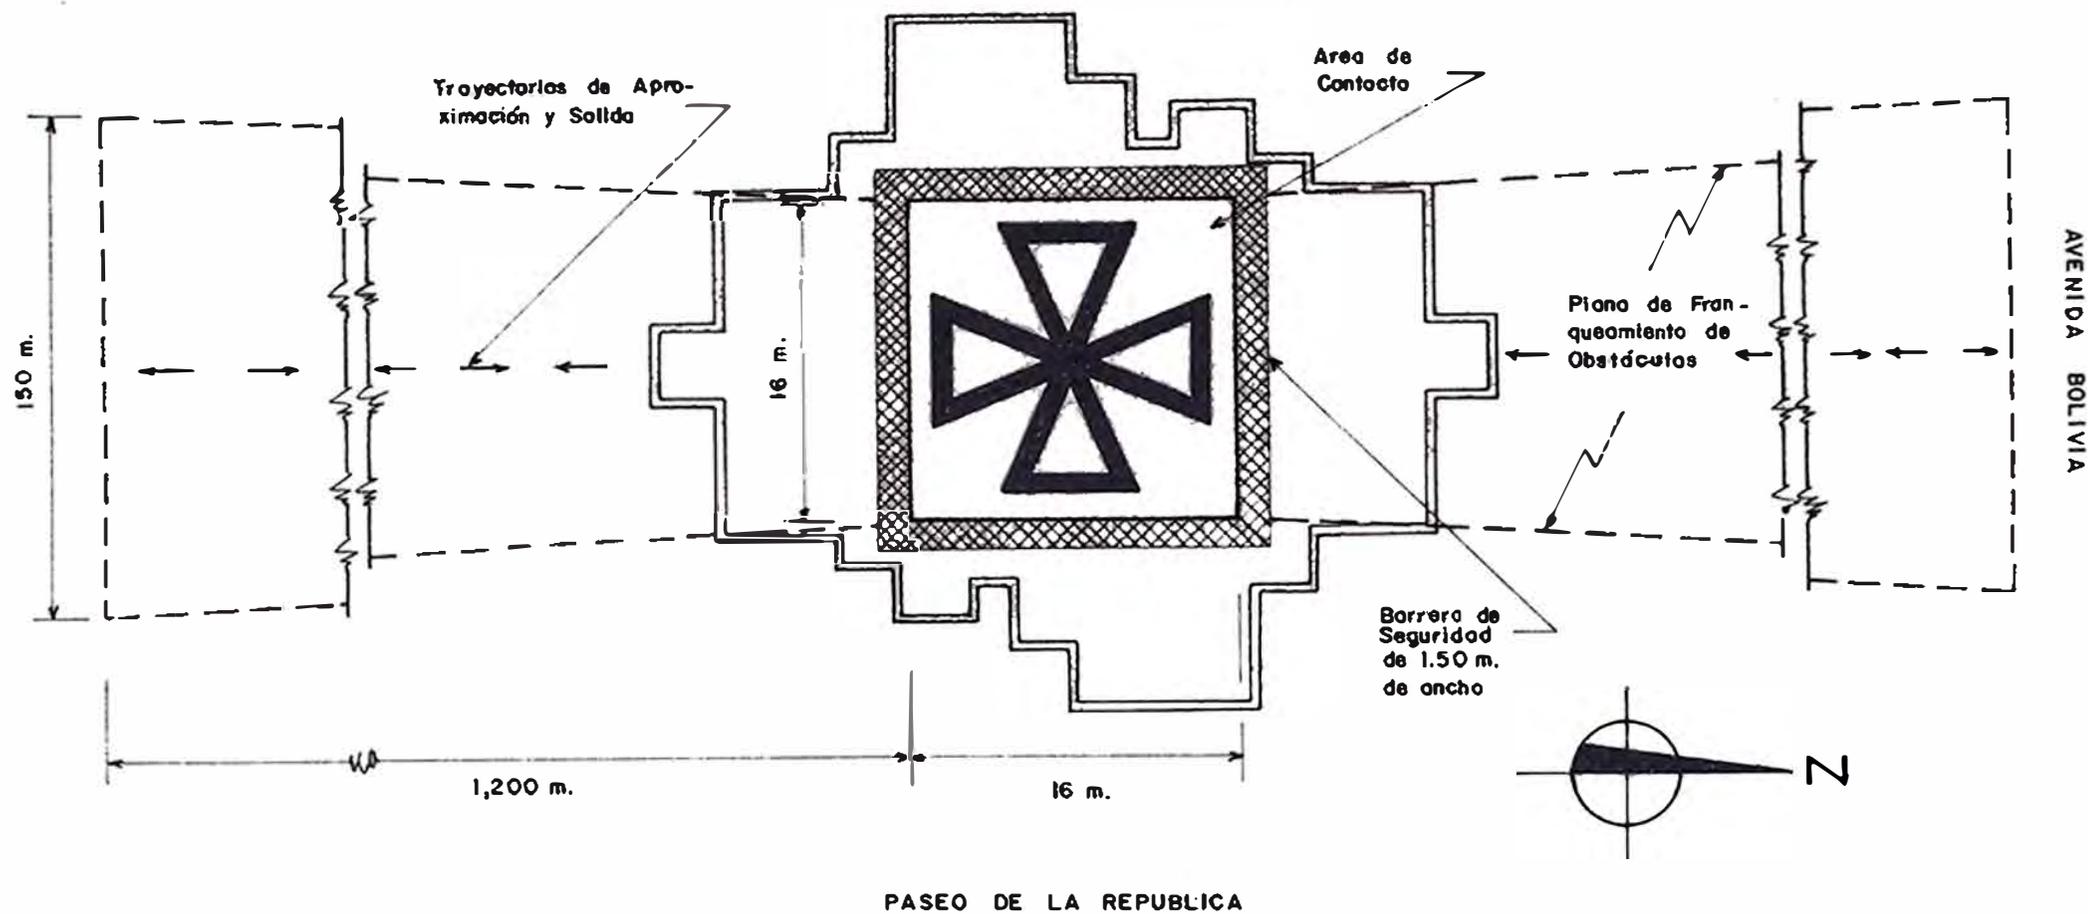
TRAZADO EN PLANTA DE UN HELIPUERTO ELEVADO EN LA TORRE DEL CENTRO CIVICO DE LIMA
